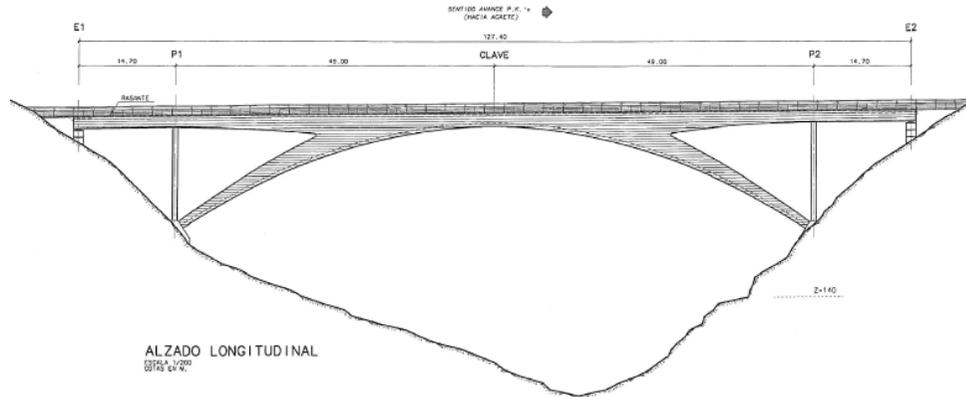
Alzado Longitudinal del Viaducto de La Palma
